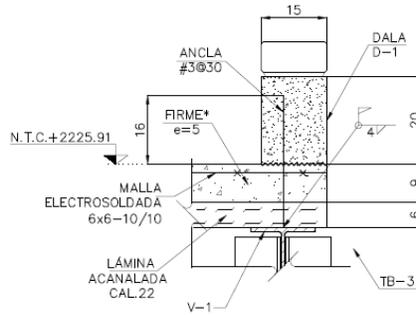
Anclaje de pozos de acceso, sobre firme de concreto equipado con losacero.
